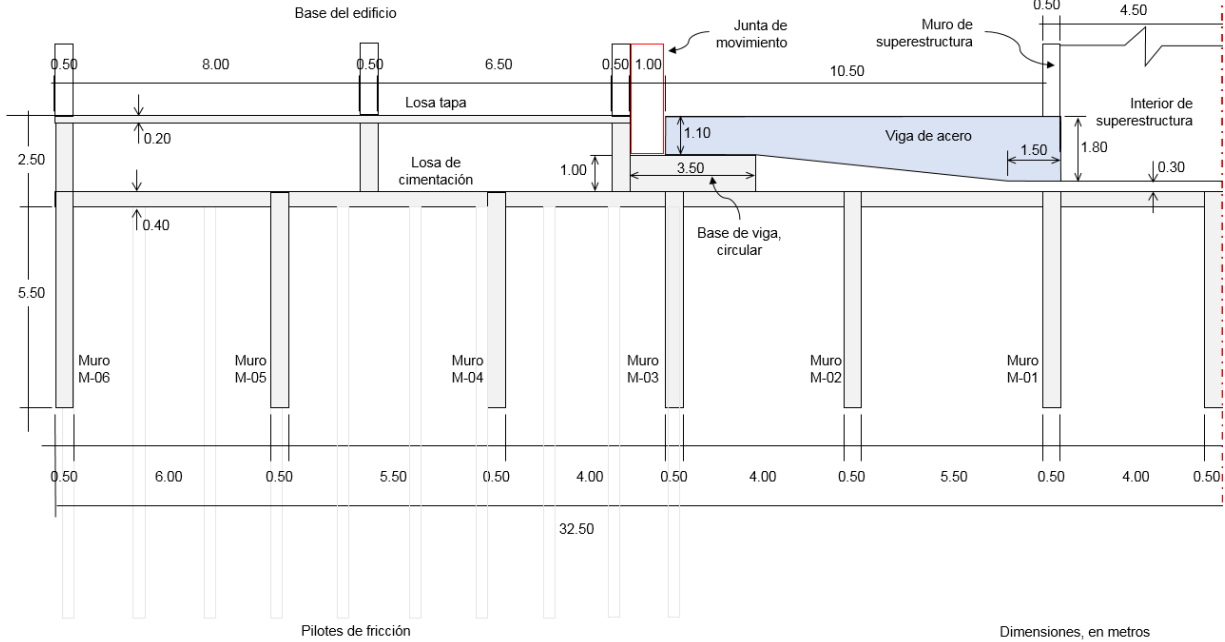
Dimensiones de los elementos que conforman el conjunto de pilotes de fricción y losa de cimentación (sección transversal)
